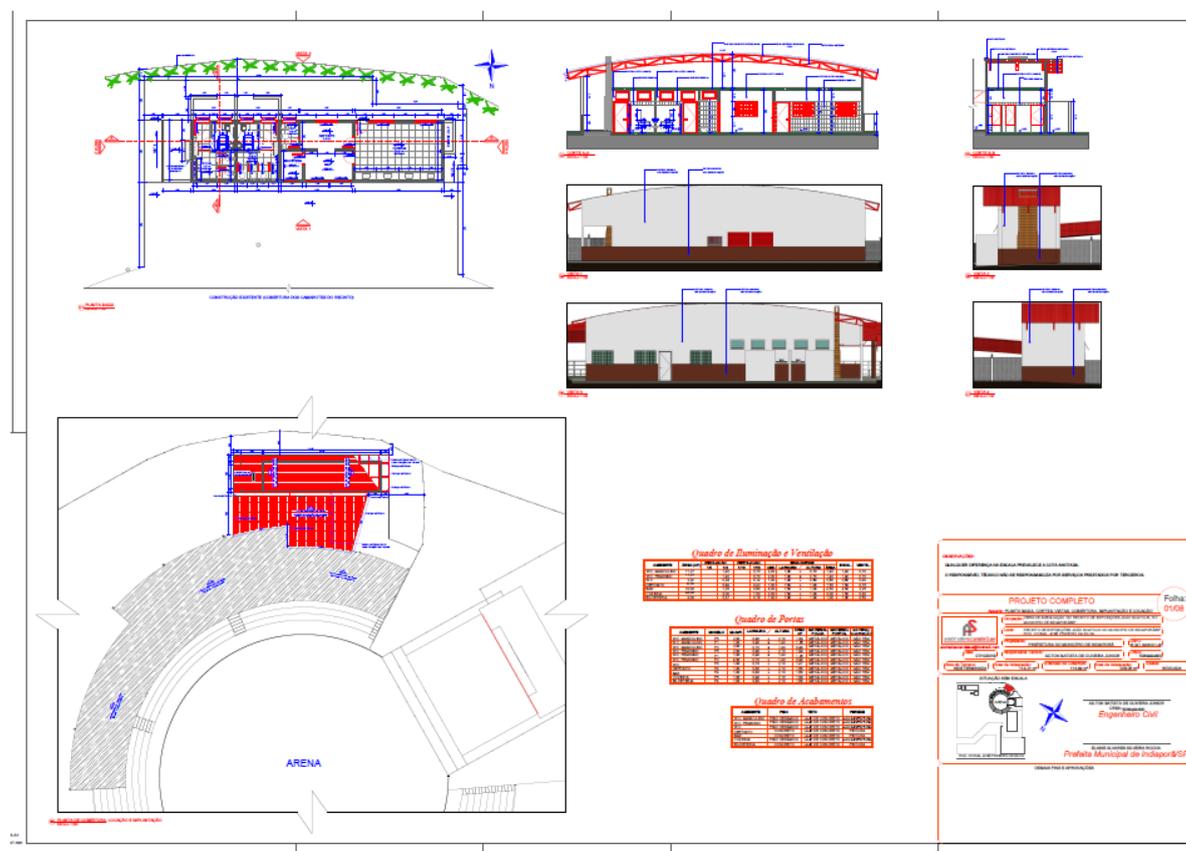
Planta baixa projeto de revitalização do centro de eventos.
